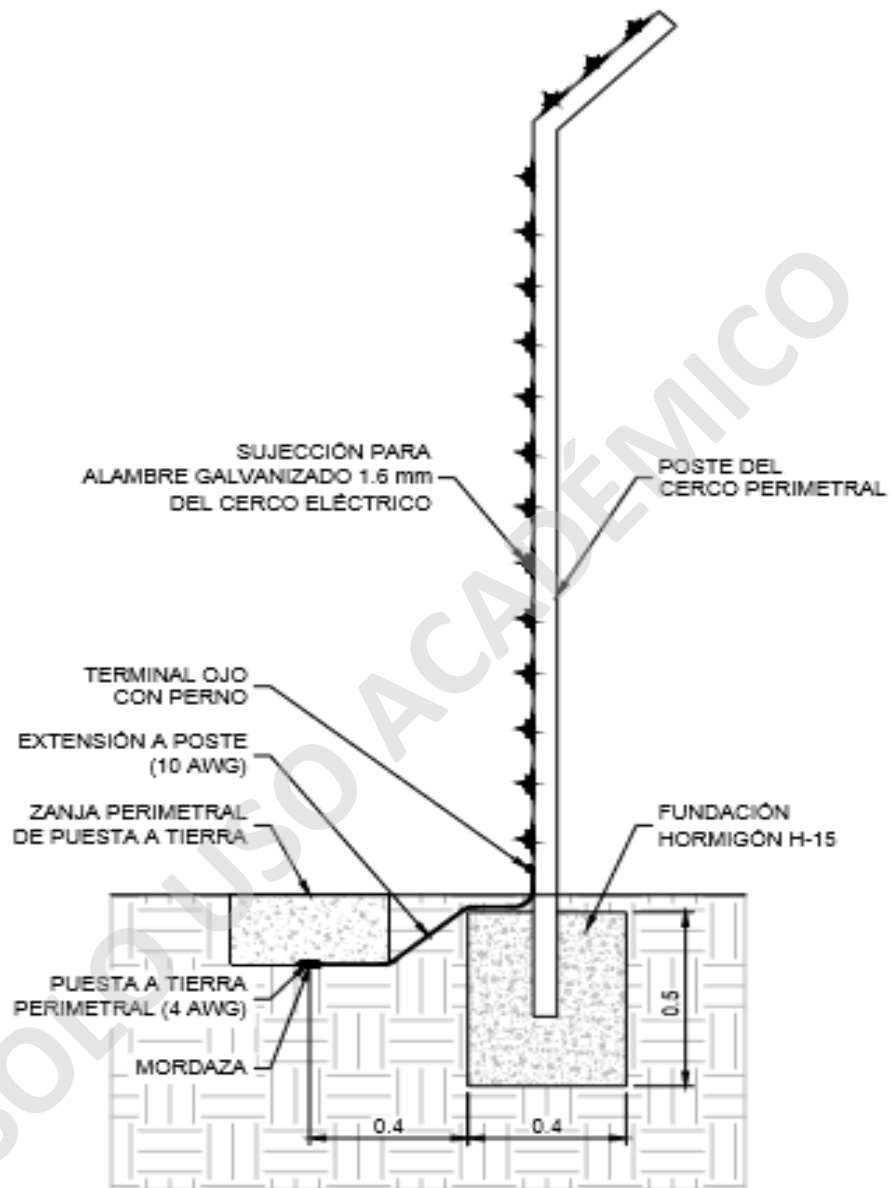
“Layout de Cerco Eléctrico en planta Fotovoltaica”
